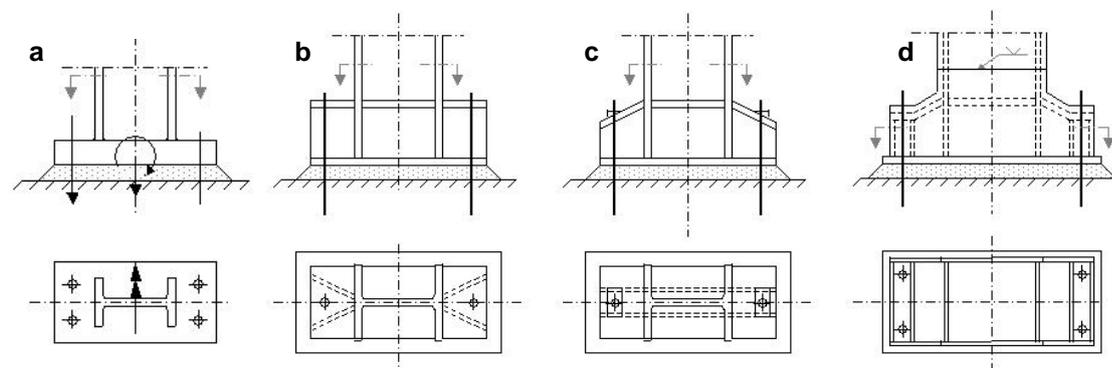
Ausführungsbeispiele für biegesteife Fußpunktstrukturen
